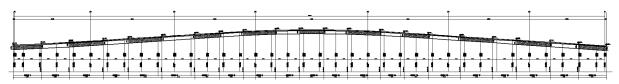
Sovrappasso di uscita – sezione longitudinale trave interno curva
